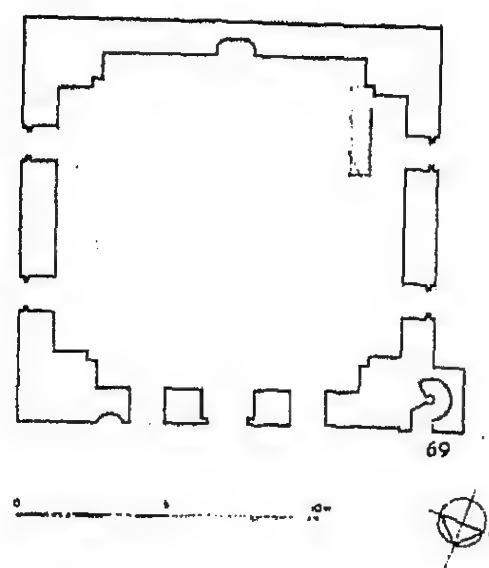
مسقط أفقي لتربة بايزيد يلدريم في بورصة (أوبروسه) (عن: Wilde).
